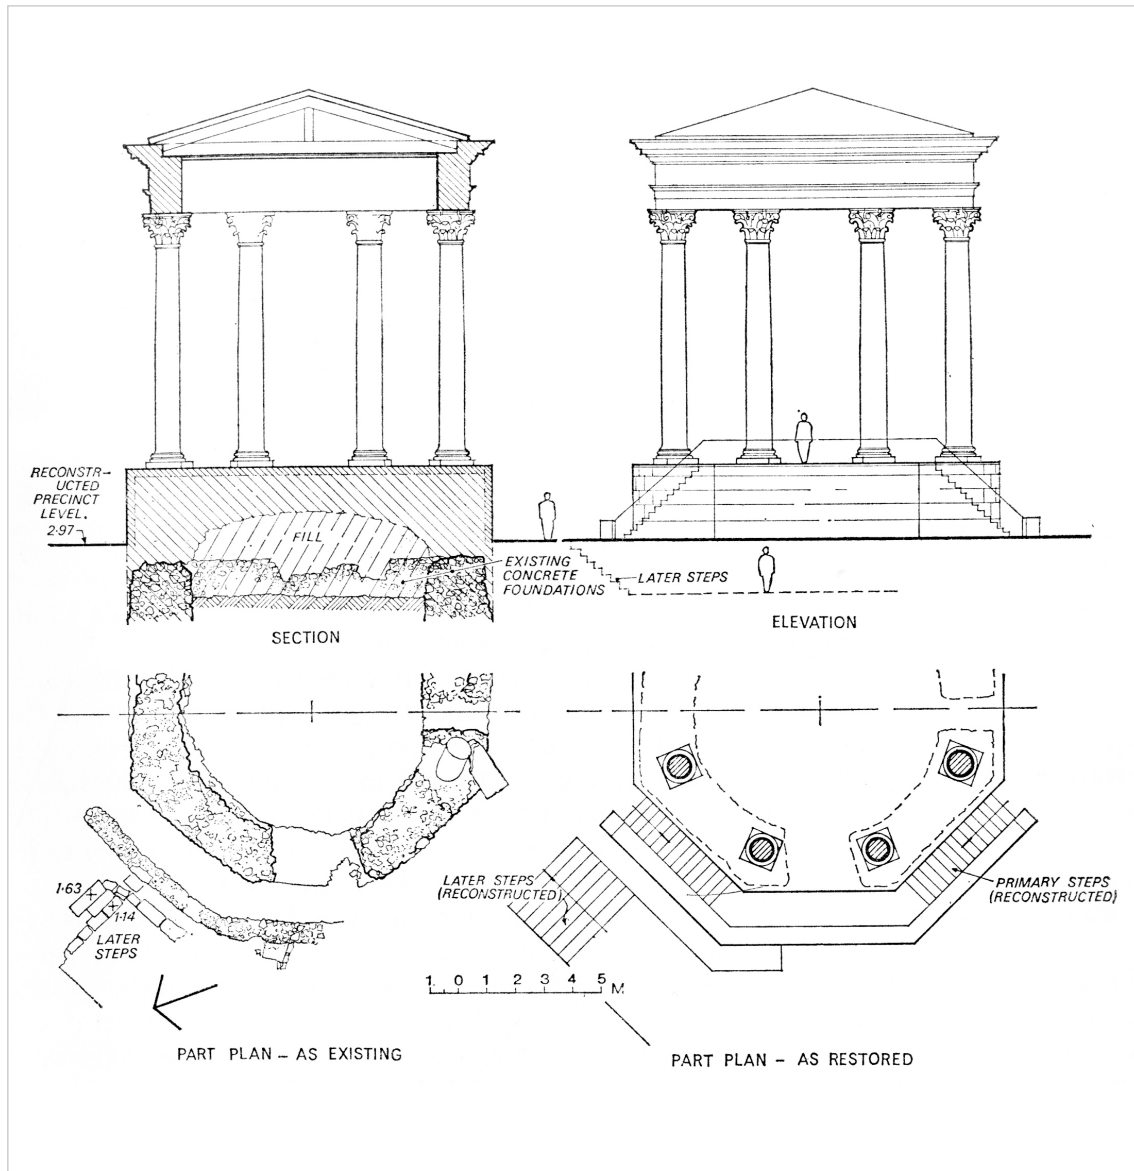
Planimetria e ipotesi di ricostruzione dell'edificio a pianta ottagonale.
